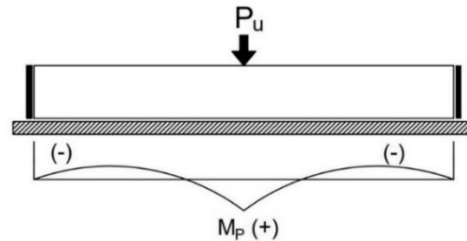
Modelo de losa con apoyo continuo sometida a una carga puntual centrada.
